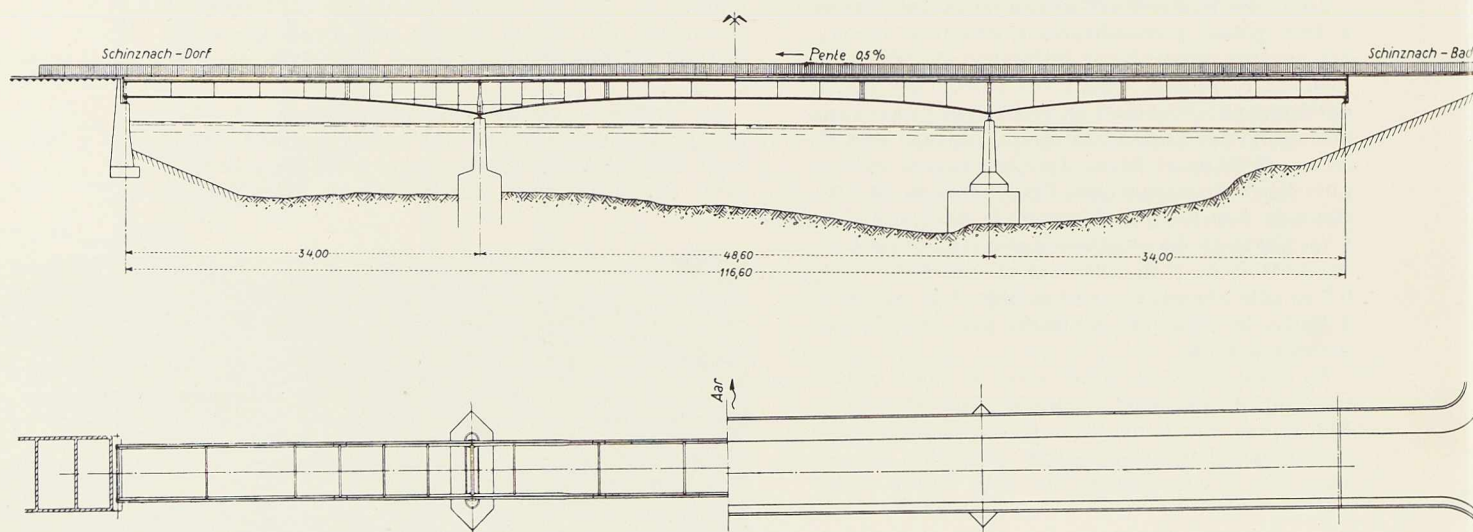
Elévation et vue en plan du pont sur l'Aar près de Schinznach.
